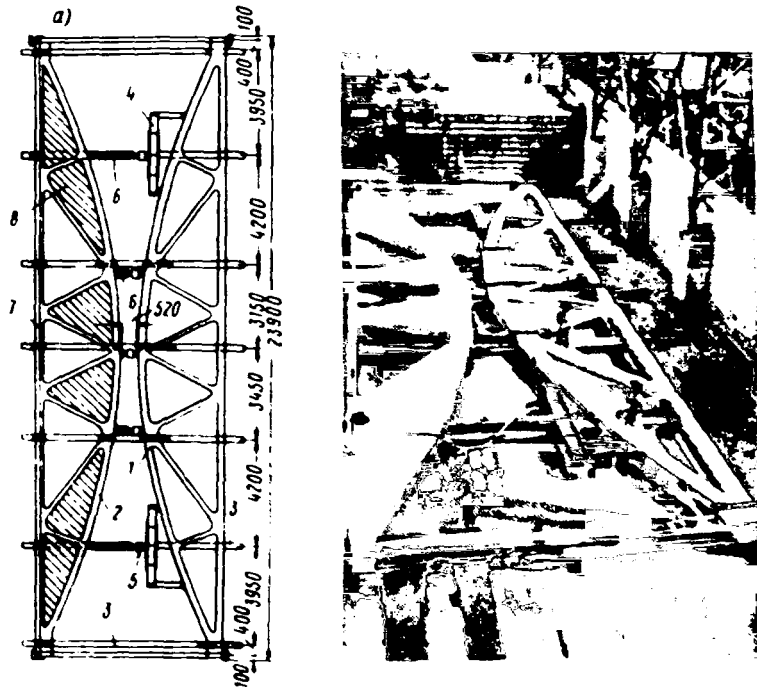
Испытание фермы в горизонтальном положении с применением усиленной вспомогательной фермы
